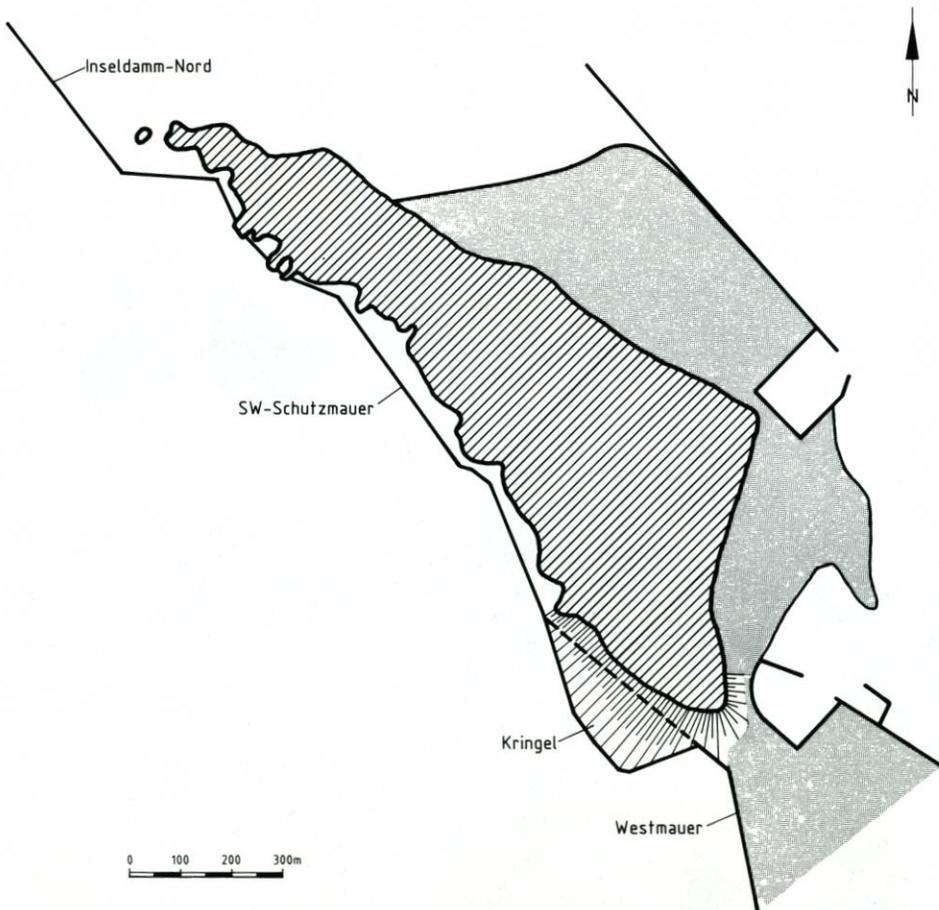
Lageplan Südwest-Schutzmauer mit Kringel
